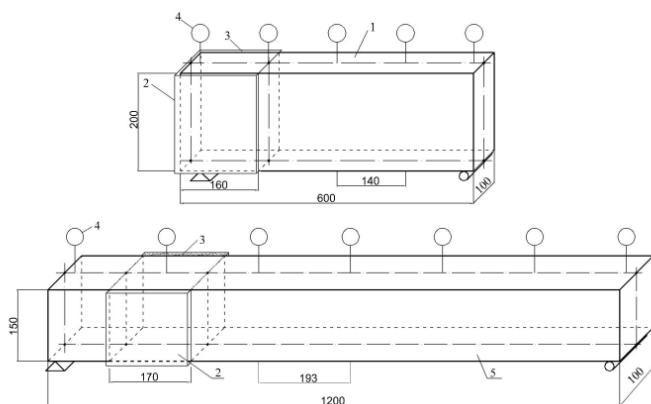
Схема проведения экспериментов. 1 – стеновой блок из газобетона; 2 – зона увлажнения; 3 – материал для водонасыщения; 4 – микронный индикатор часового типа; 5 – неармированная бетонная балка
